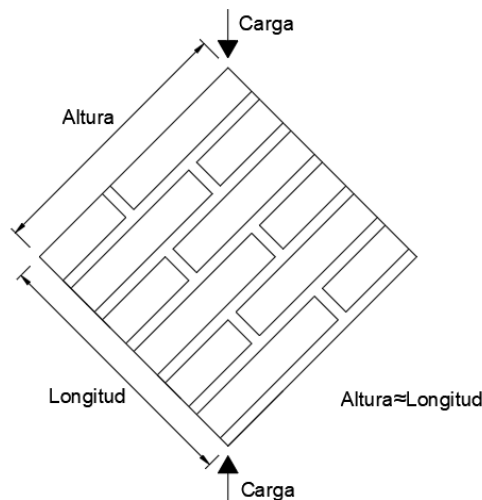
Murete para prueba en compresión diagonal. (adaptado de [23])
